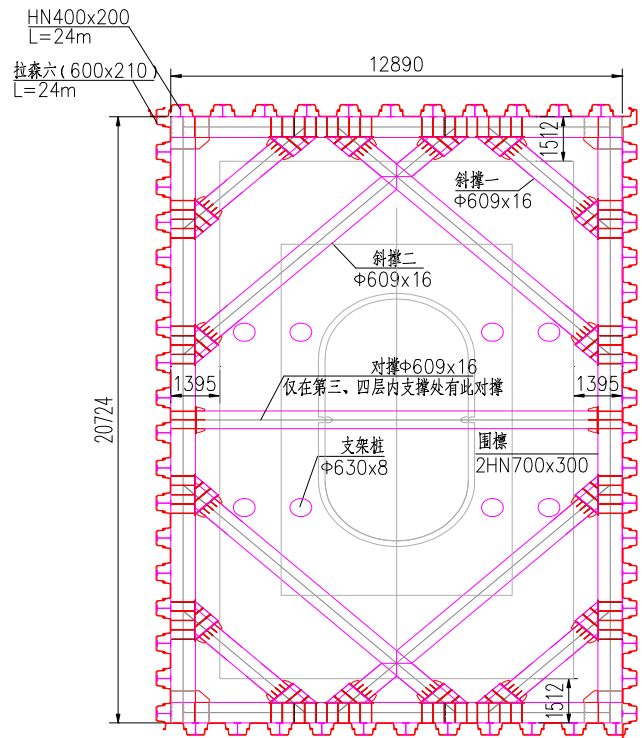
东司马港连续梁 159#、160#墩拉森钢板桩围堰支撑平面布置
